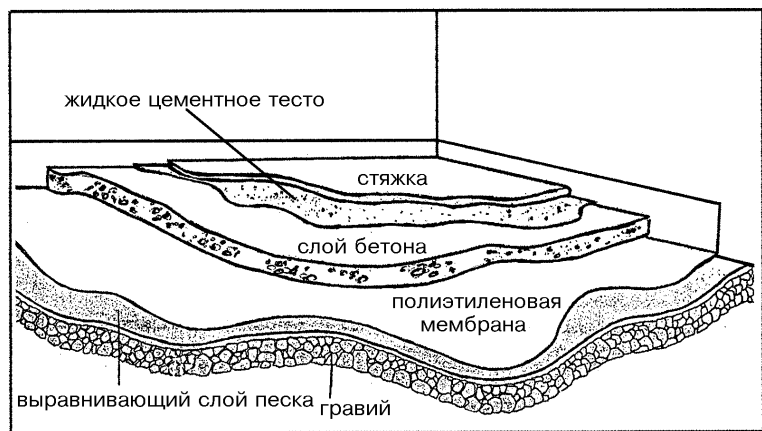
Конструкция цементно-песчаной стяжки по бетонному основанию
